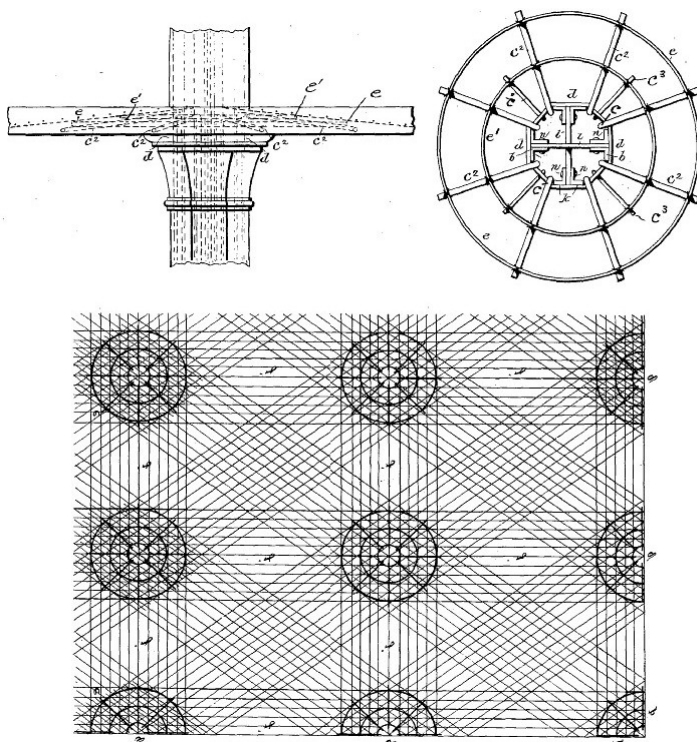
Безбалочные перекрытия К. А. П. Тернера
